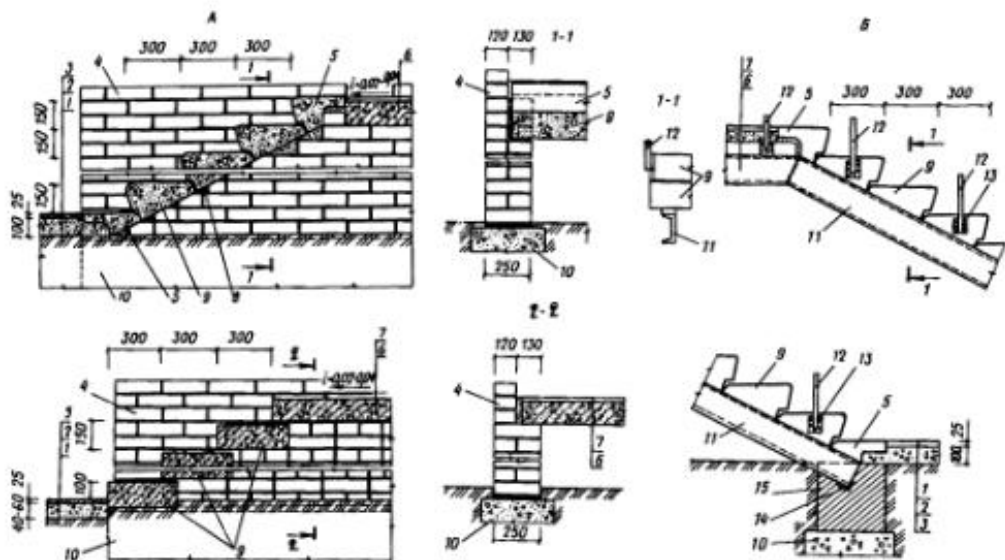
Детали устройства лестниц наружных входов: А - из железобетонных элементов; Б - цокольный марш по металлическим косоурам; 1 - уплотнённый грунт; 2 - то же, щебень; 3 - асфальтобетон; 4 - боковая опорная кирпичная стенка; 5 - фризная ступень; 6 - плита входной площадки; 7 - керамическая плитка; 8 - цементно-песчаный раствор; 9 - основные ступени; 10 - фундамент; 11 - стальной косоур; 12 - стойка ограждения; 13 - сварка; 14 - опорный уголок на ширину лестничного марша; 15 - нижняя опорная кирпичная стенка
